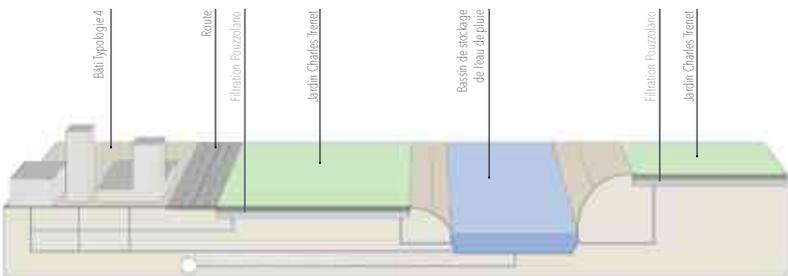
Dessins personnels, intervention sur le Jardin Charles Trenet, coupe schématique plan
